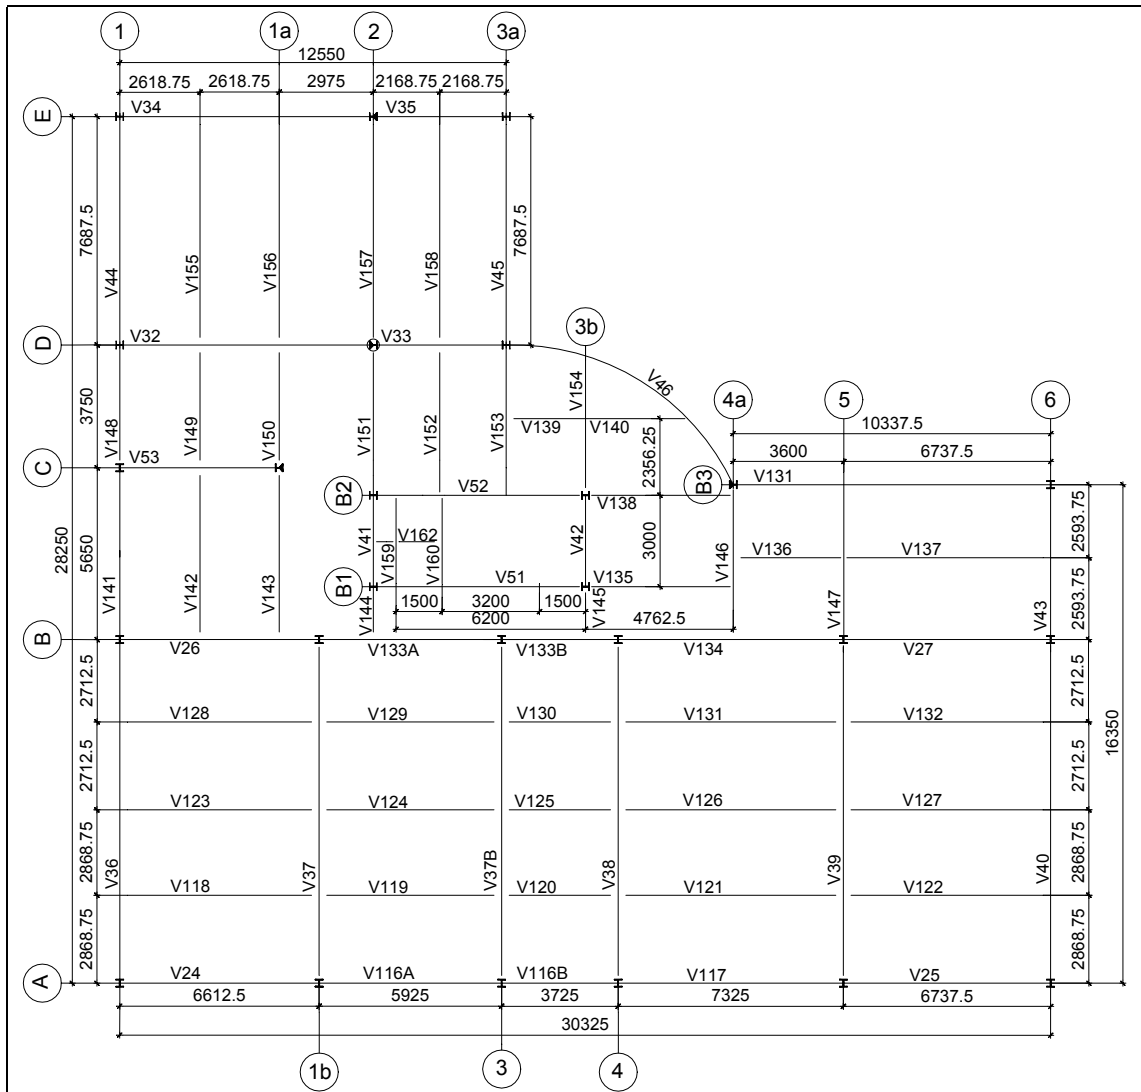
Vigamento do Pavimento 2 do Edifício 3 – EL. 6000 mm.
